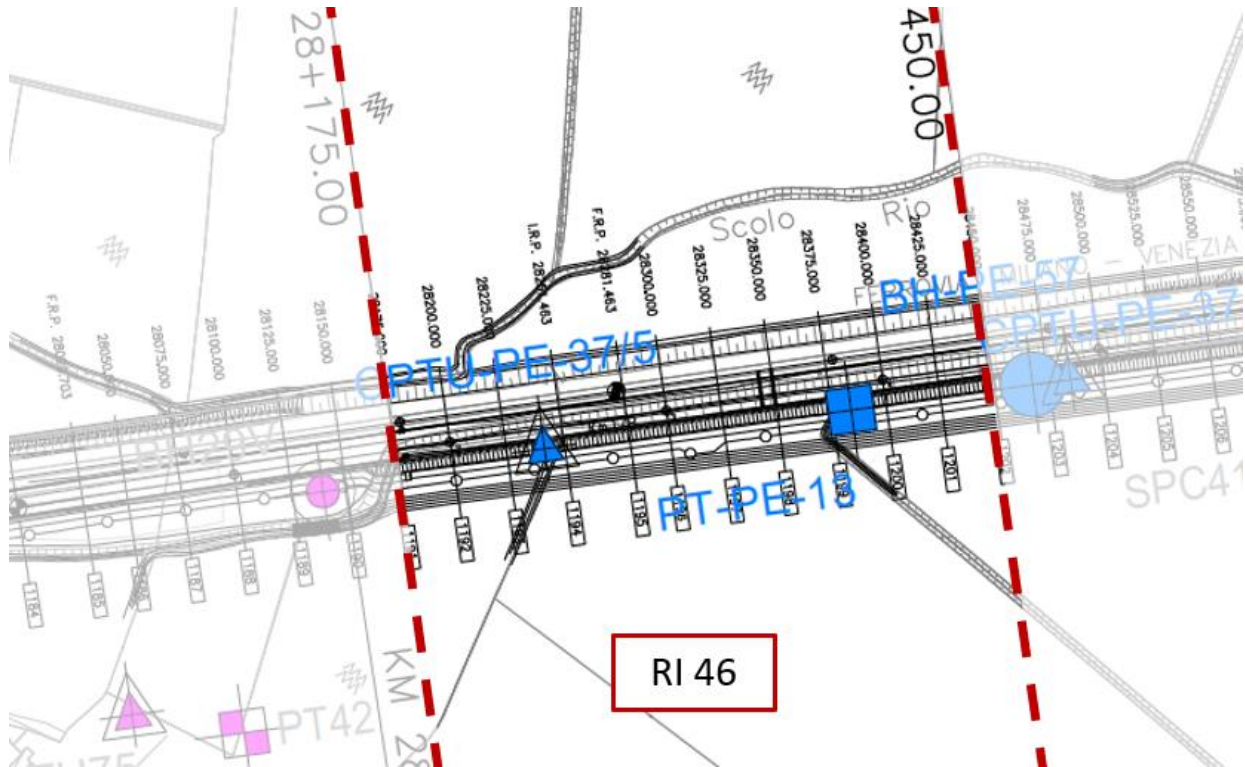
Planimetria Rilevato RI46, estratto dalla Planimetria Generale (Doc. Rif. [3])
